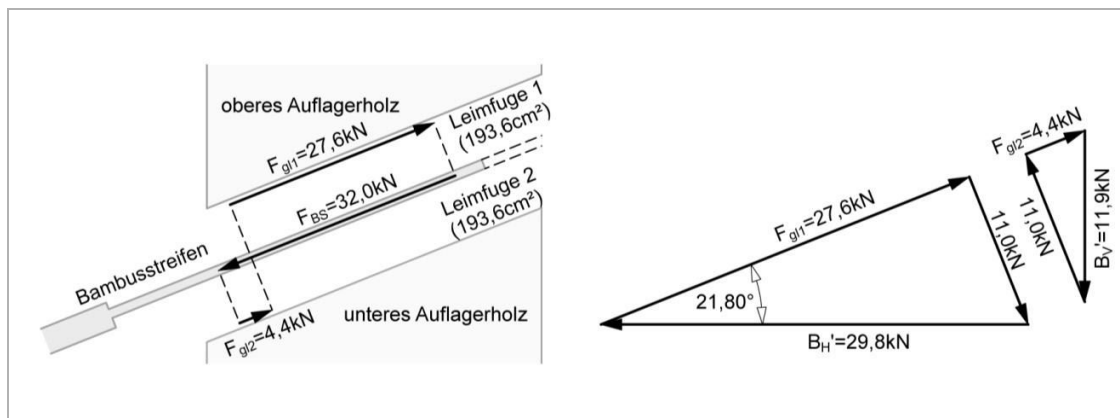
Kräftegleichgewicht der Leimfugen und Kräfteplan der Auflagerreaktionen am Auflager B.
